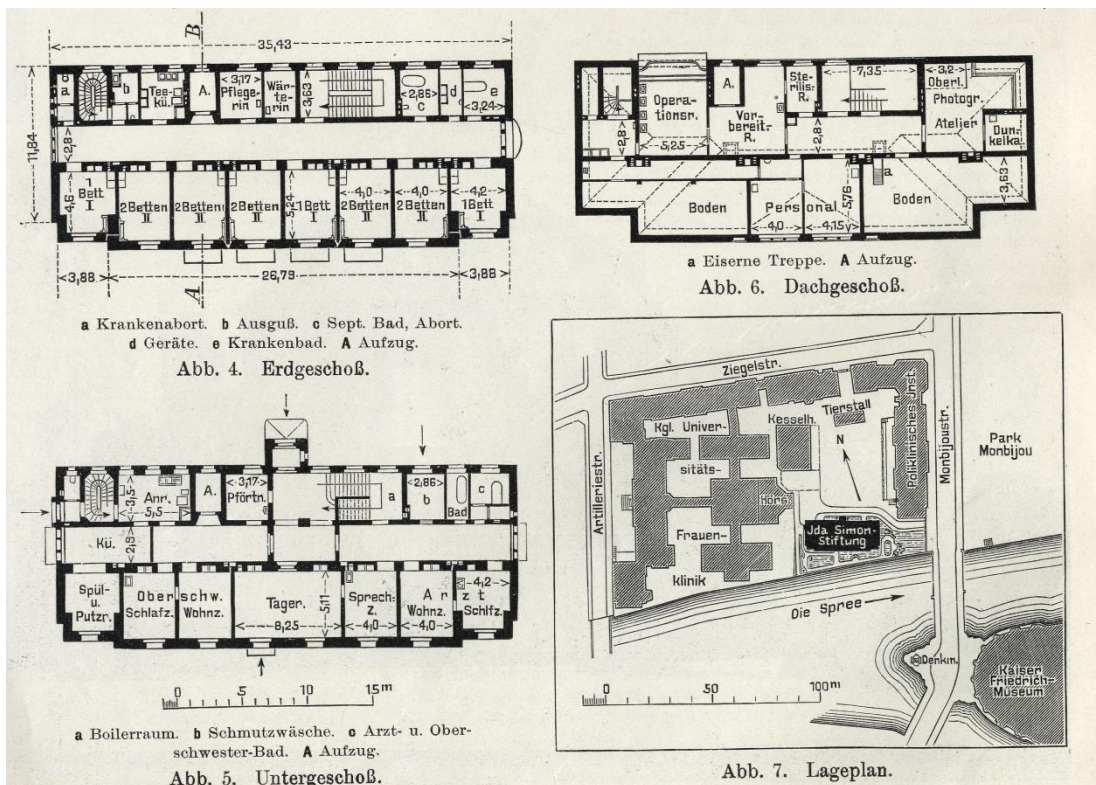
Lageplan und Grundriss der Ida-Simon-Stiftung (Brüstlein 1911 S. 346)
